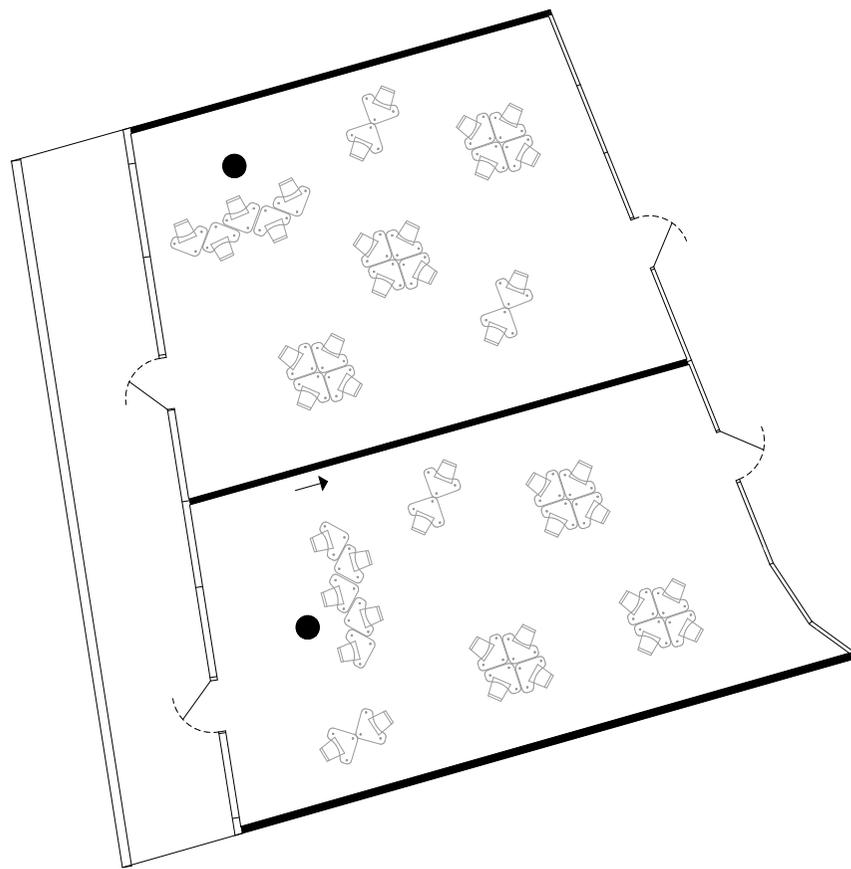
Bildungsraum mit Schiebewände - Grundriss
